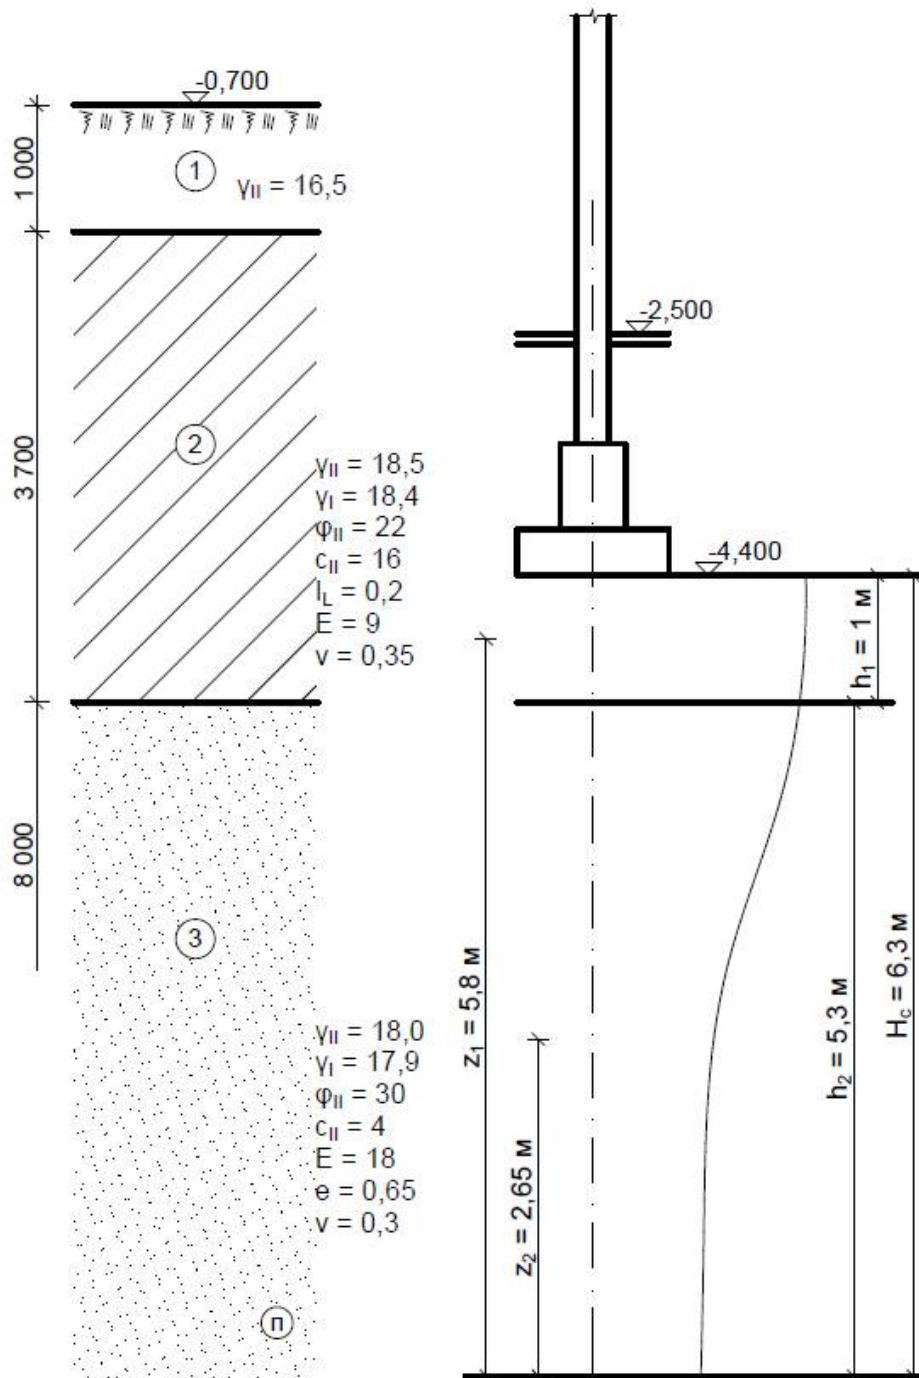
Розрахункова схема для визначення осідання фундаменту експрес-методом
